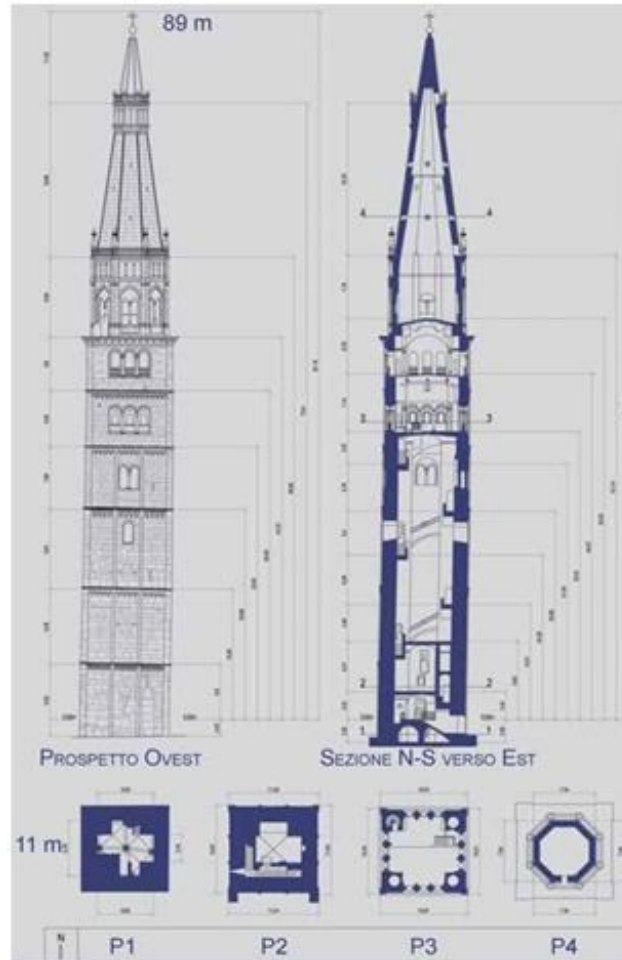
Prospetto Ovest, sezione Nord-Sud e piante della Ghirlandina (Cadignani, 2010).
